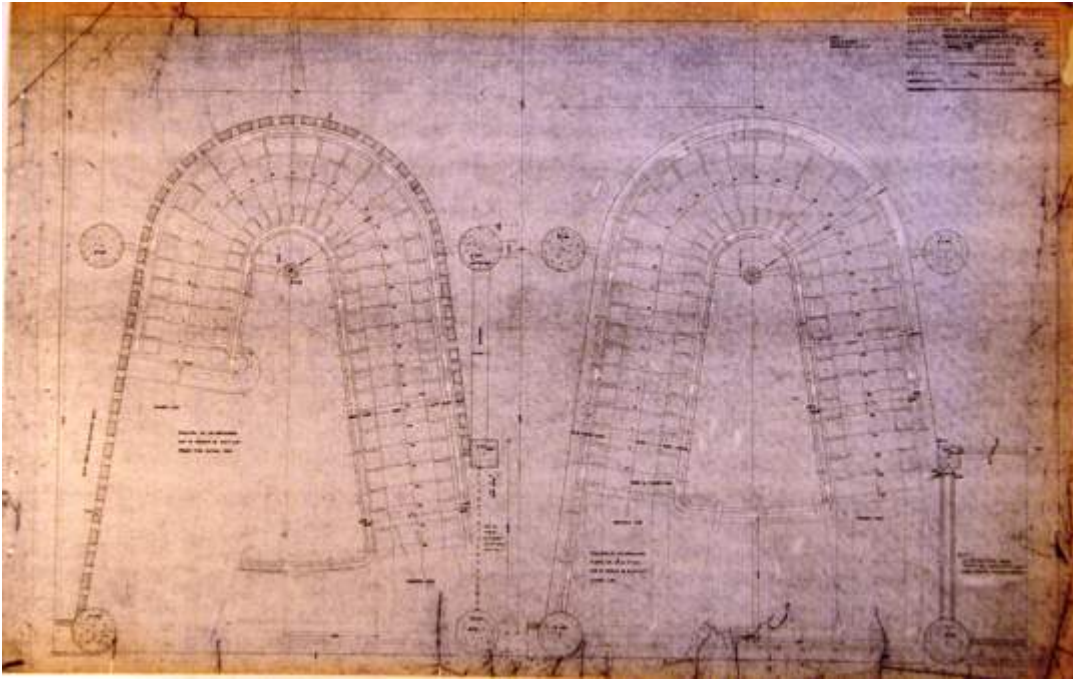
Detalles de la escalera de los empleados. Nuevamente, la escalera dispone de un mástil central, ligado a las columnas de la cuadrícula estructural. Archivo MALR. Centro Cívico de Barranquilla. Carpeta B. Proyecto 481 B. 25 de mayo de 1951.
